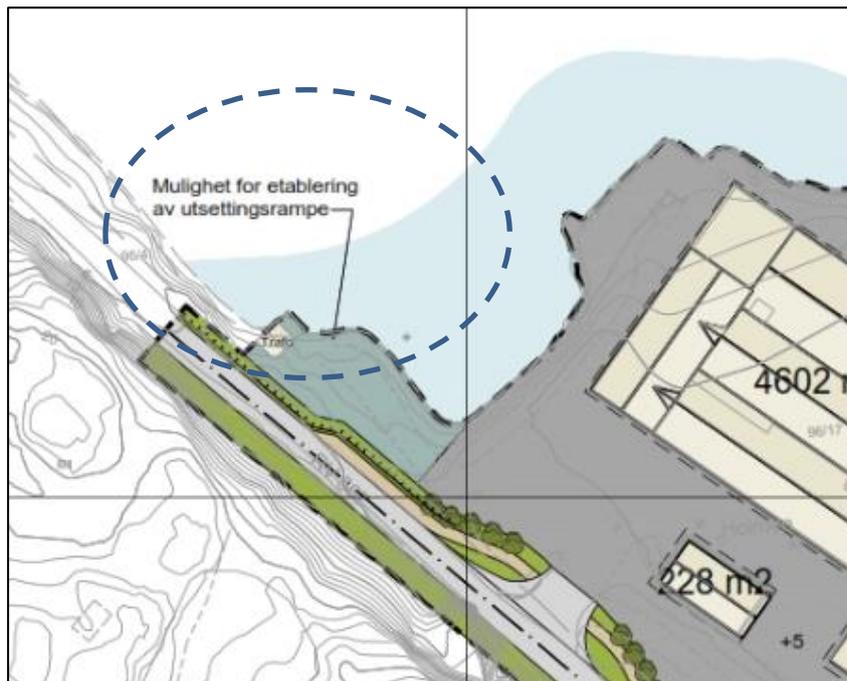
Eksisterande småbåthamn og planlagt utfylling.
